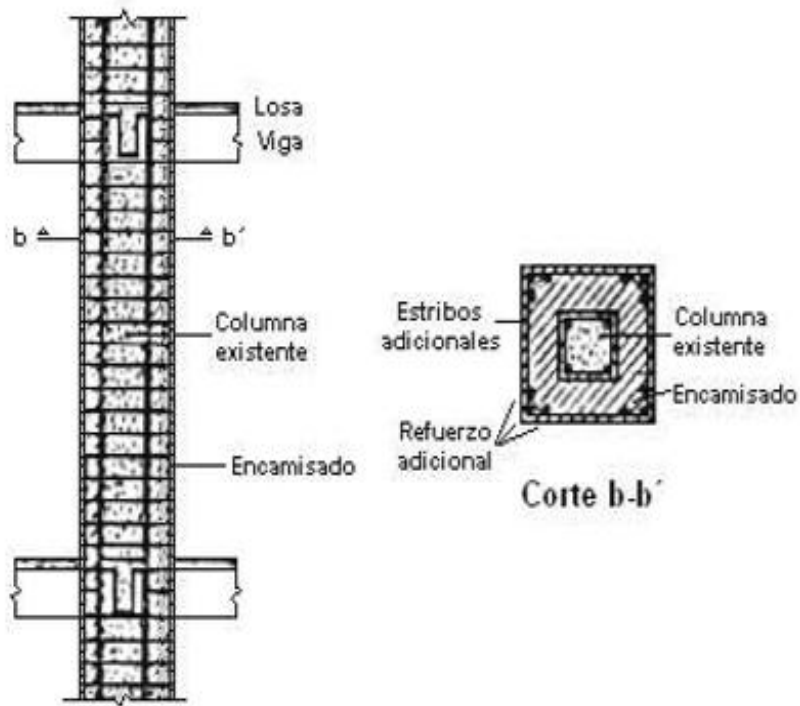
, Encamisado de una columna hasta la losa (UNDP/UNIDO,1983)
